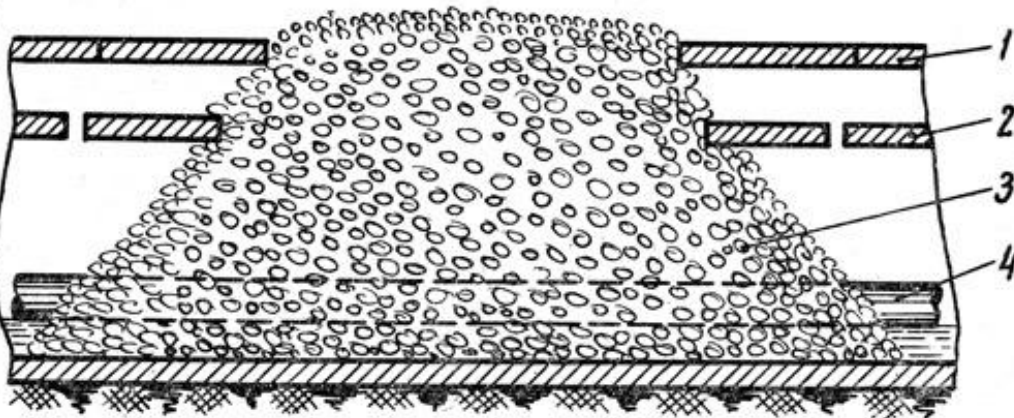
Конструкция пожарной перемишки [предлагаемый вариант]:
